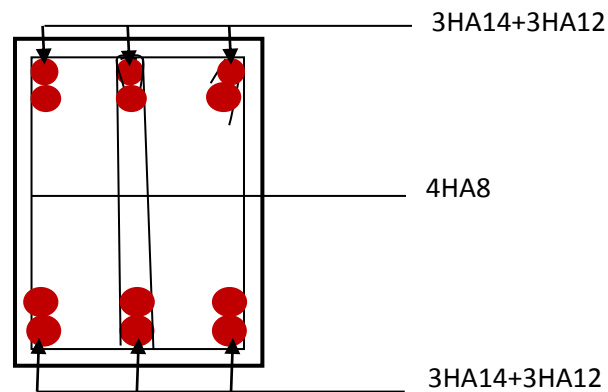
Ferrailage sur appuis d'une poutre principale.
